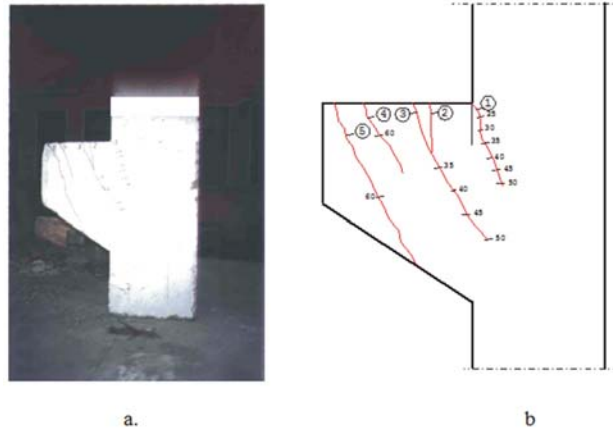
Relevu fisuri consolă reabilitată: a. vedere element fisurat; b. relevu fisuri
